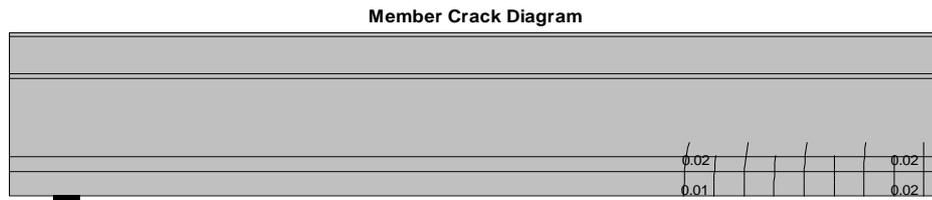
Pola retak akhir balok beton pracetak BU1.
